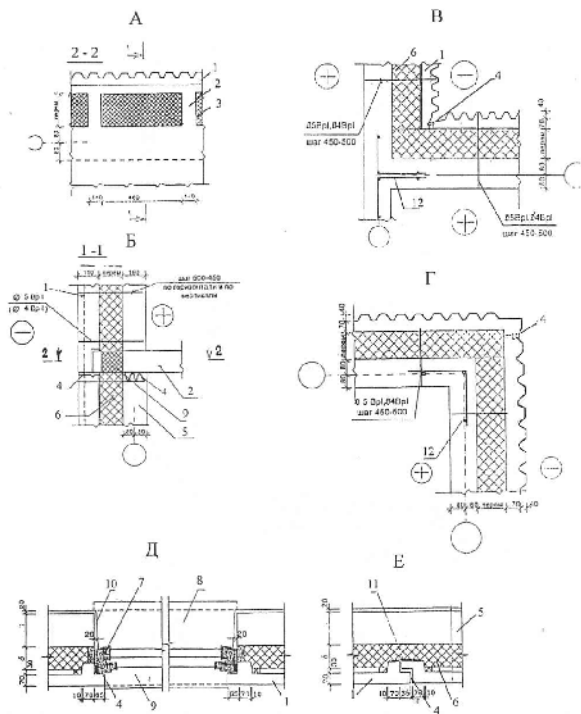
Детали наружных стен, облицованных сборными железобетонными скорлупами с рифленой фасадной поверхностью: А – в уровне монолитного перекрытия; Б – горизонтального стыка; В – входящего угла наружных стен, Г – то же, выступающего; детали наружных стен, облицованных скорлупами с гладкой фасадной поверхностью и ребрами внутри; Д – сопряжение с оконным блоком; Е – вертикального стыка: 1 – рифленая скорлупа, 2 – перфорированный наружный участок монолитного перекрытия, 3 – песгораемый утеплитель, 4 – упругая прокладка, 5 – внутренний слой наружной стены, 6 – утеплитель, 7 – оконный блок, 8 – подоконная доска, 9 – слив из оцинкованной стали, 10 – штукатурка откоса, 11 – стальная пластина, 12 – гнутый арматурный каркас
